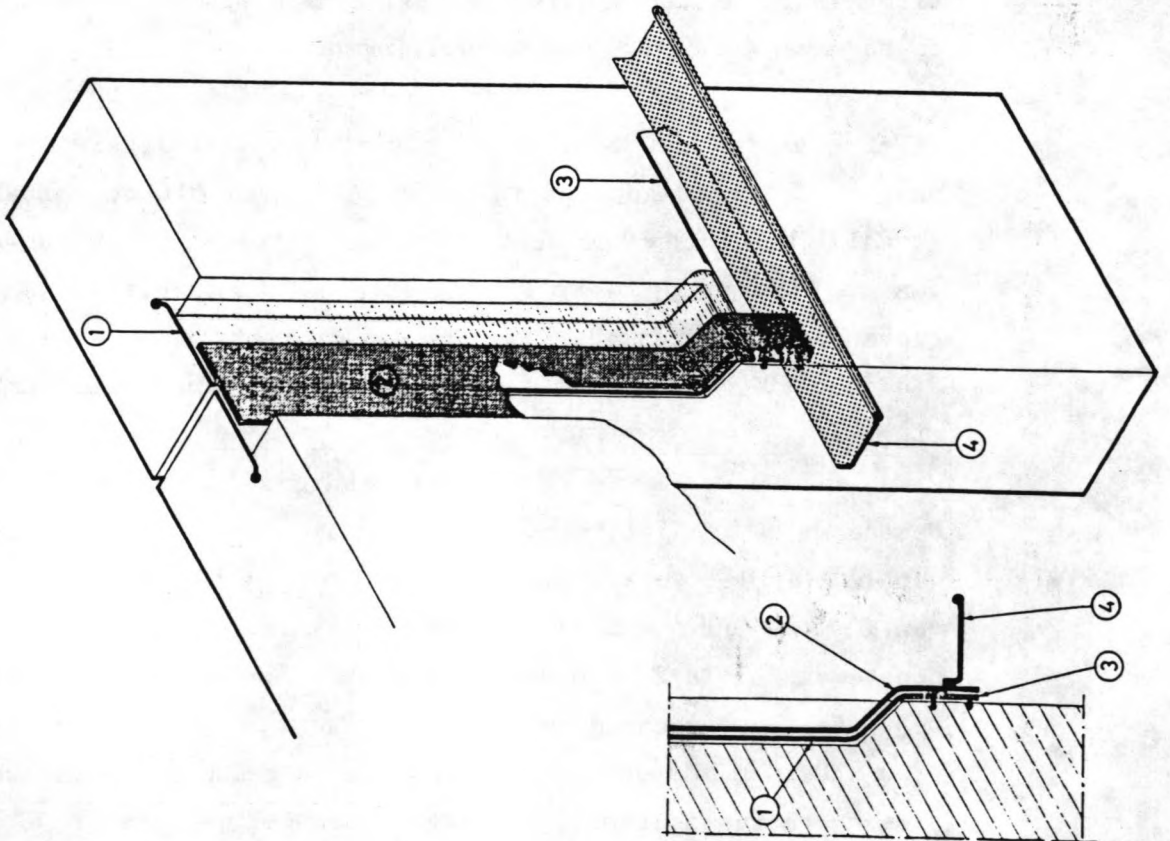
DETAIL DU JOINT D'ETANCHEITE (TYPE W.S.I.)
